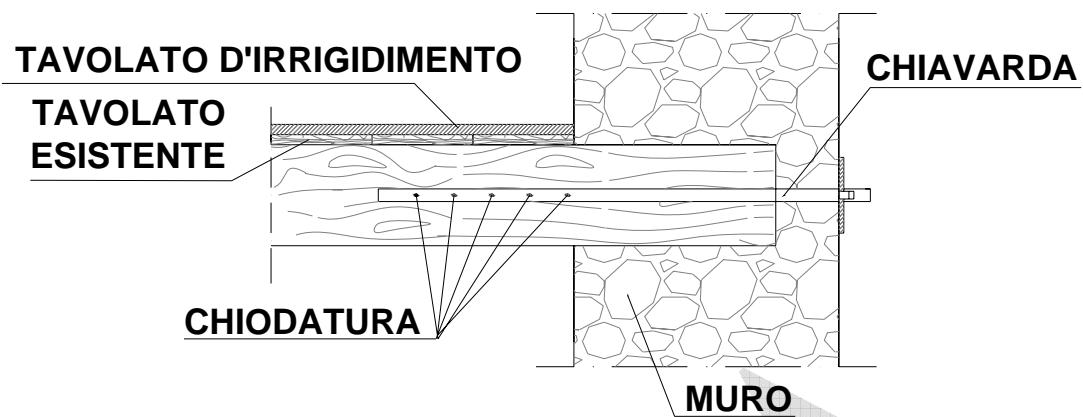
Schema di irrigidimento di solaio in legno con tavolato ortogonale e collegamento trave-muro
